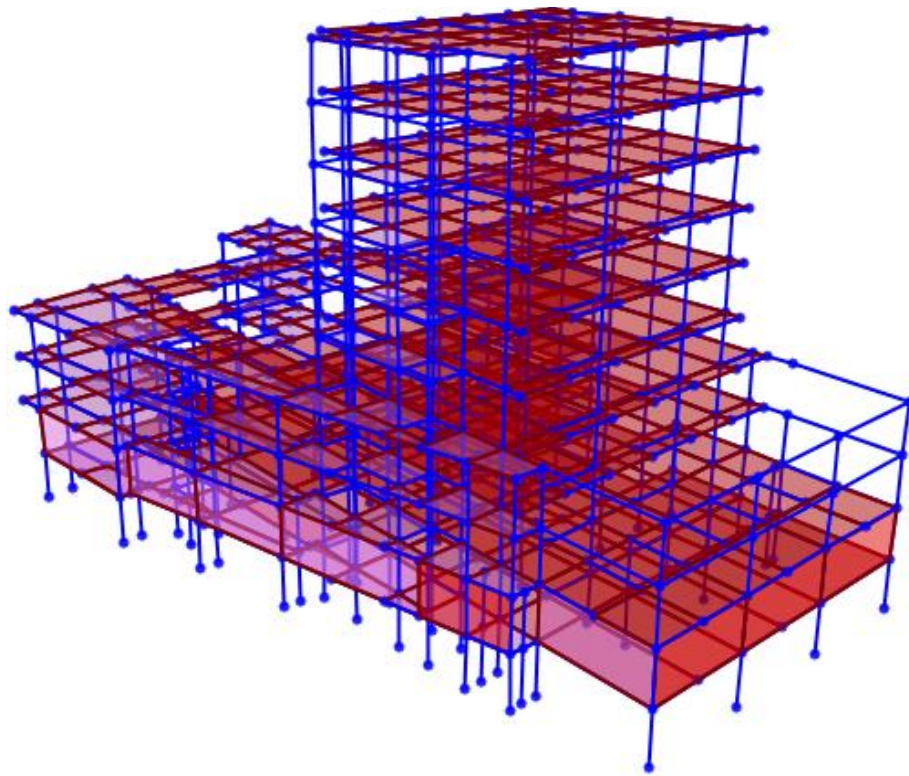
8 Model 3D Struktur Dengan Corewall Tampak Depan
